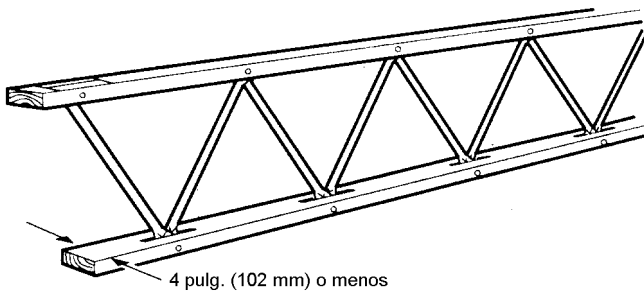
(b)(i)1 Construcción con viguetas de celosía de madera.
